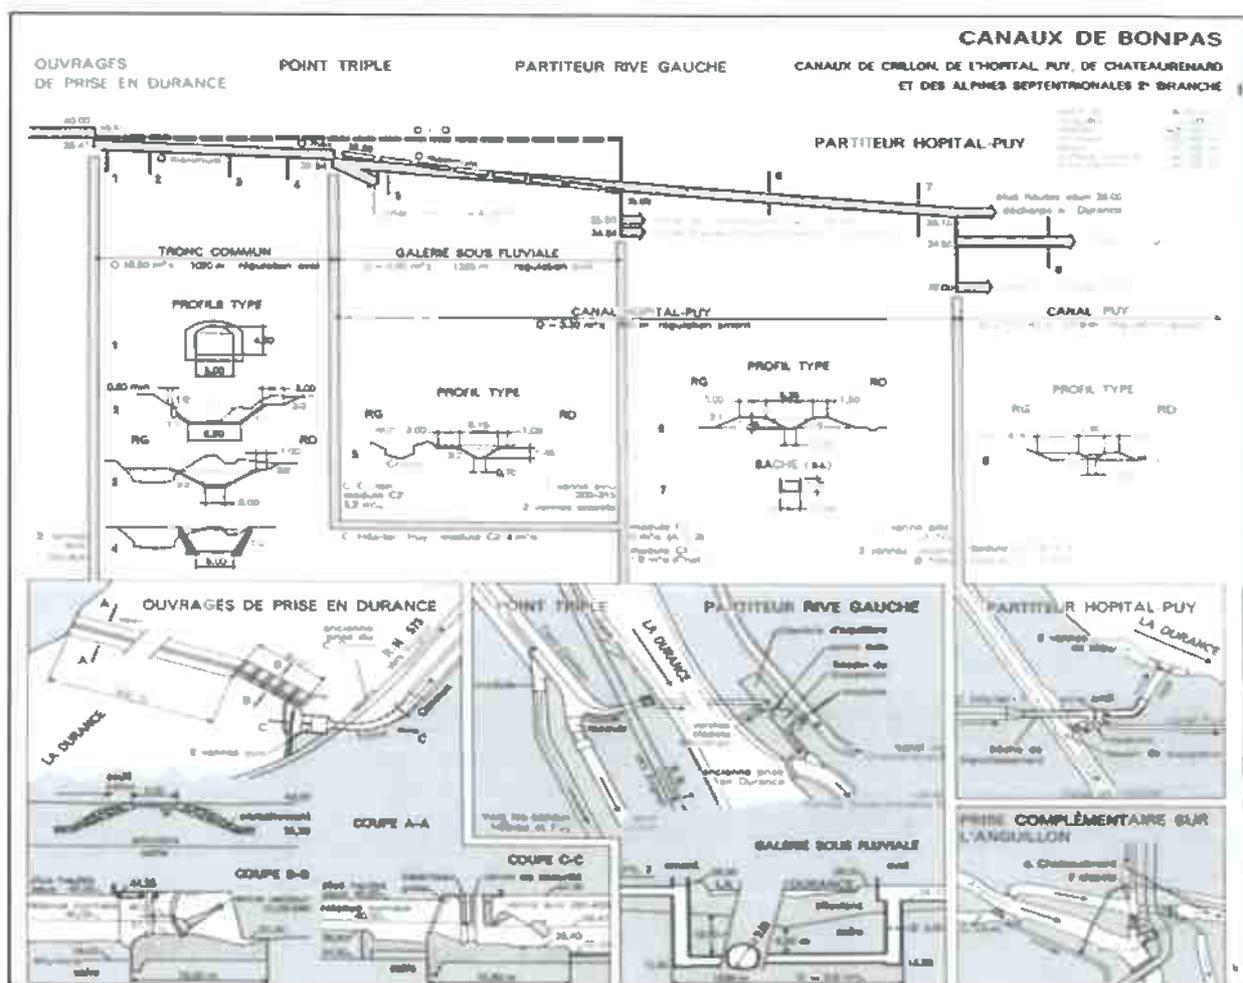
EDF - Plans schématiques des ouvrages de prise en Durance
